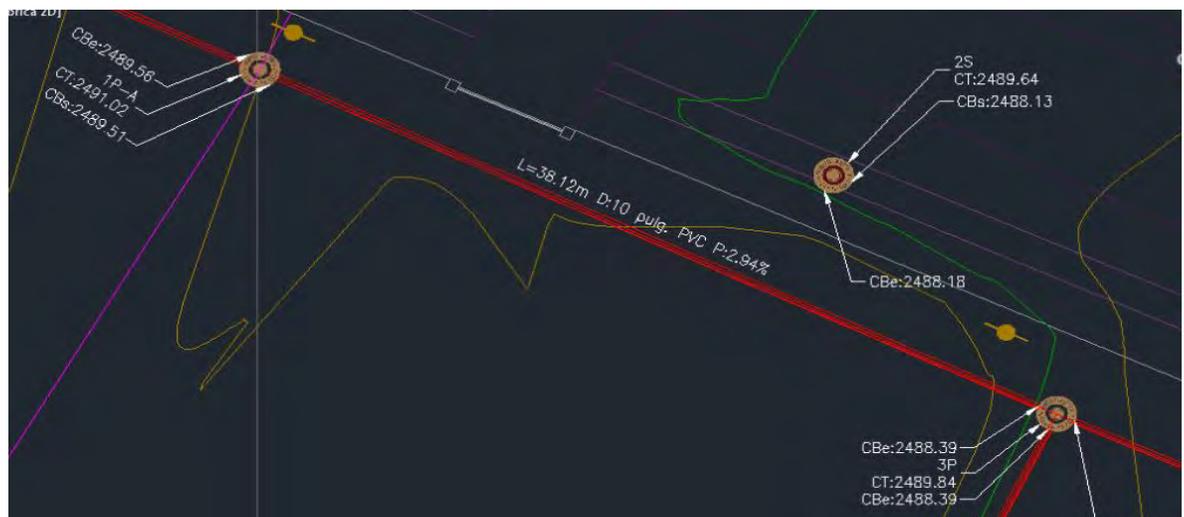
Plano general diseño alcantarillado pluvial.
